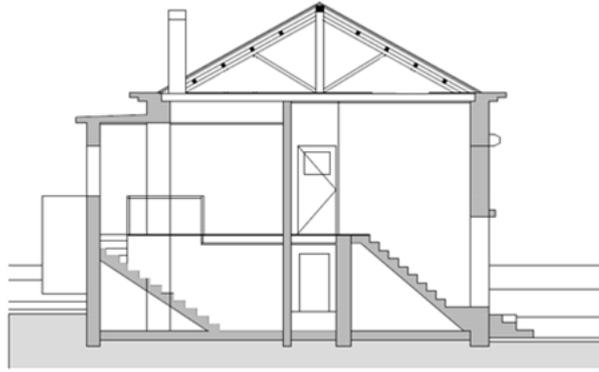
17 - Corte transversal (S1) (Fonte: do autor).
